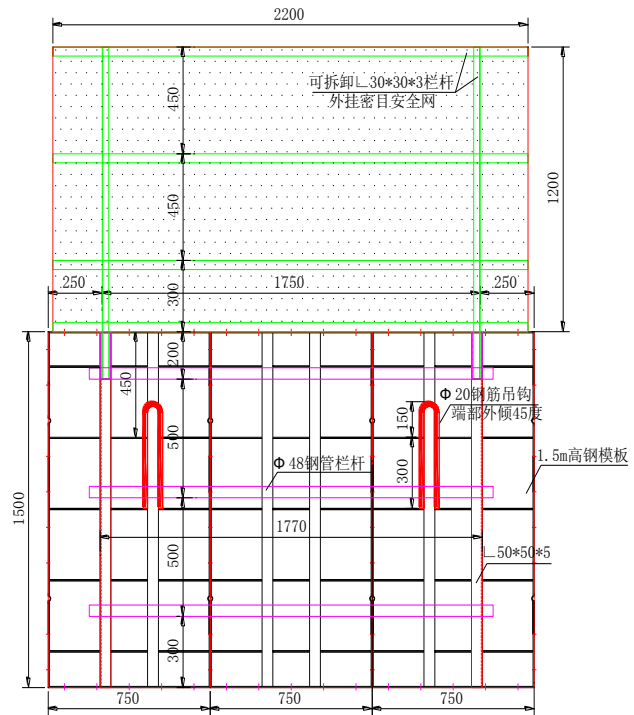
模板钢架施工平台布置正立面图 (单位: mm)
